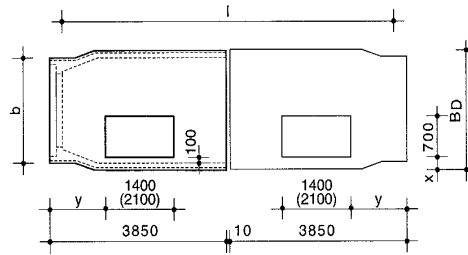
Lage der Einstiegsöffnung bei KSch Typ II, Länge 7,20 m, geteilte Decke
